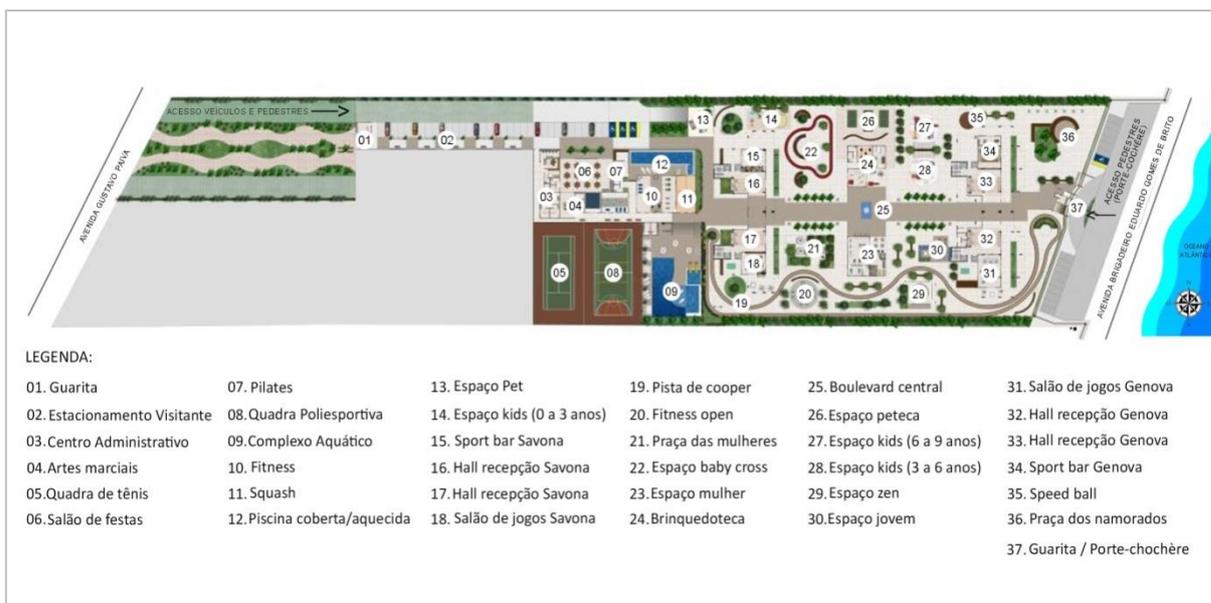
Planta baixa do pilotis do condomínio Riviera Del Mare com a localização dos ambientes
